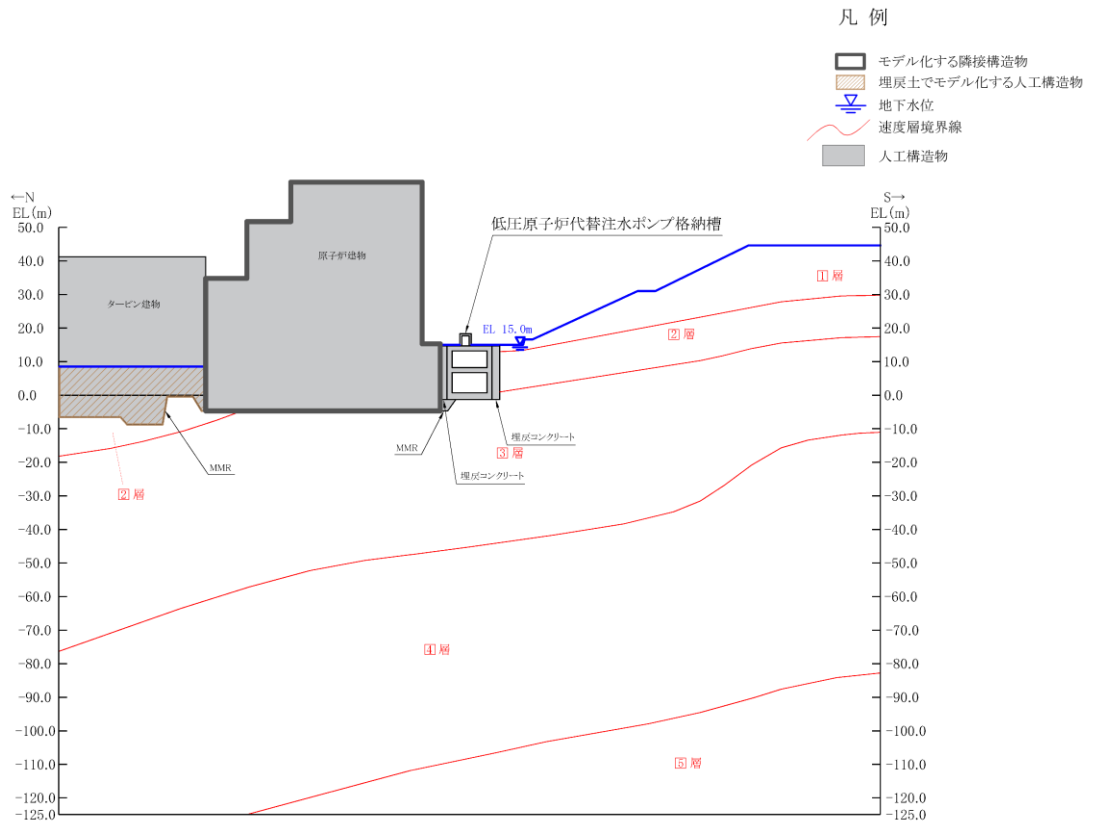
低圧原子炉代替注水ポンプ格納槽 評価対象断面図 (A-A 断面位置)
